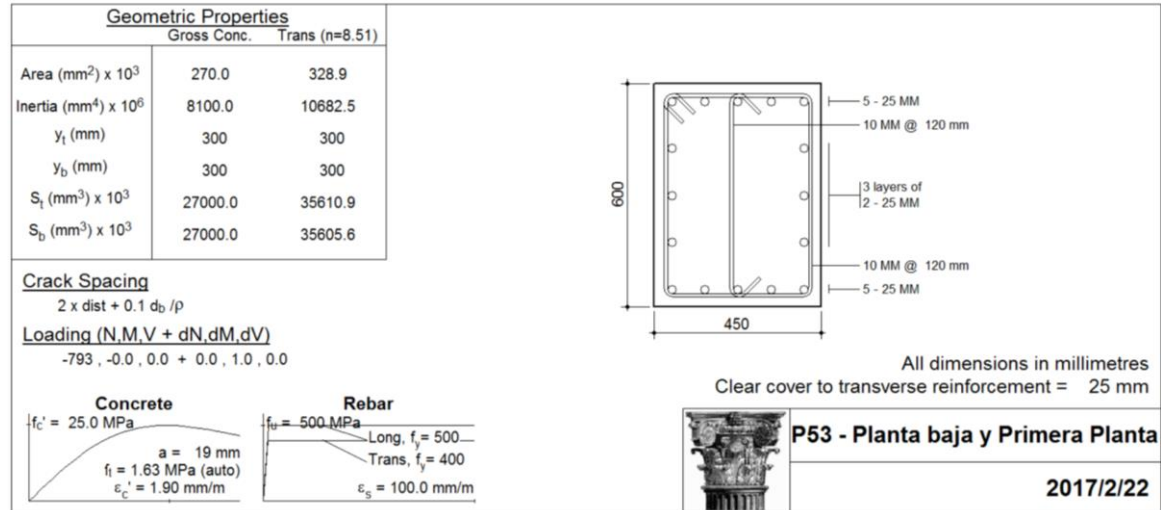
Datos del pilar 53 en planta baja y primera planta (Ref. [6])
